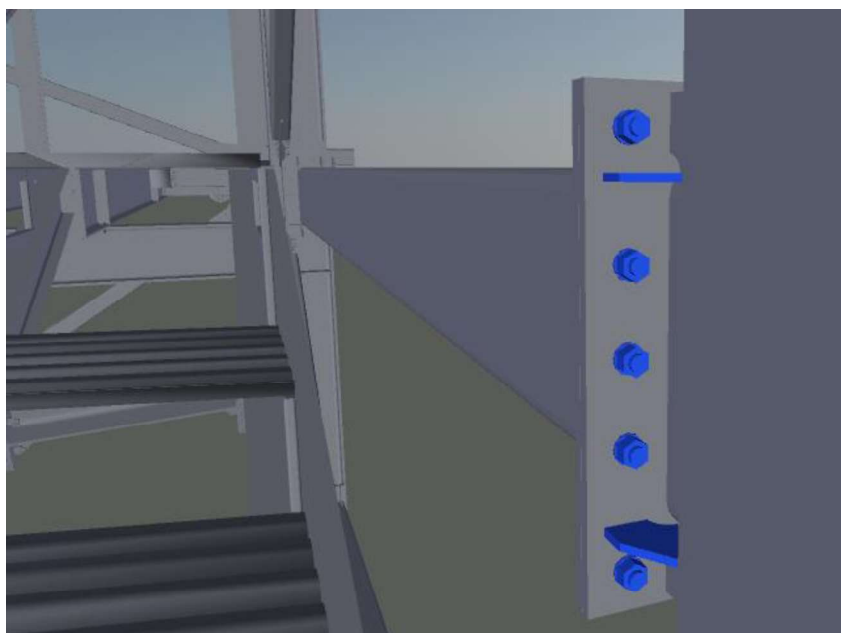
Pormenor de ligação do Projeto de Estrutura disponibilizado em formato IFC.
